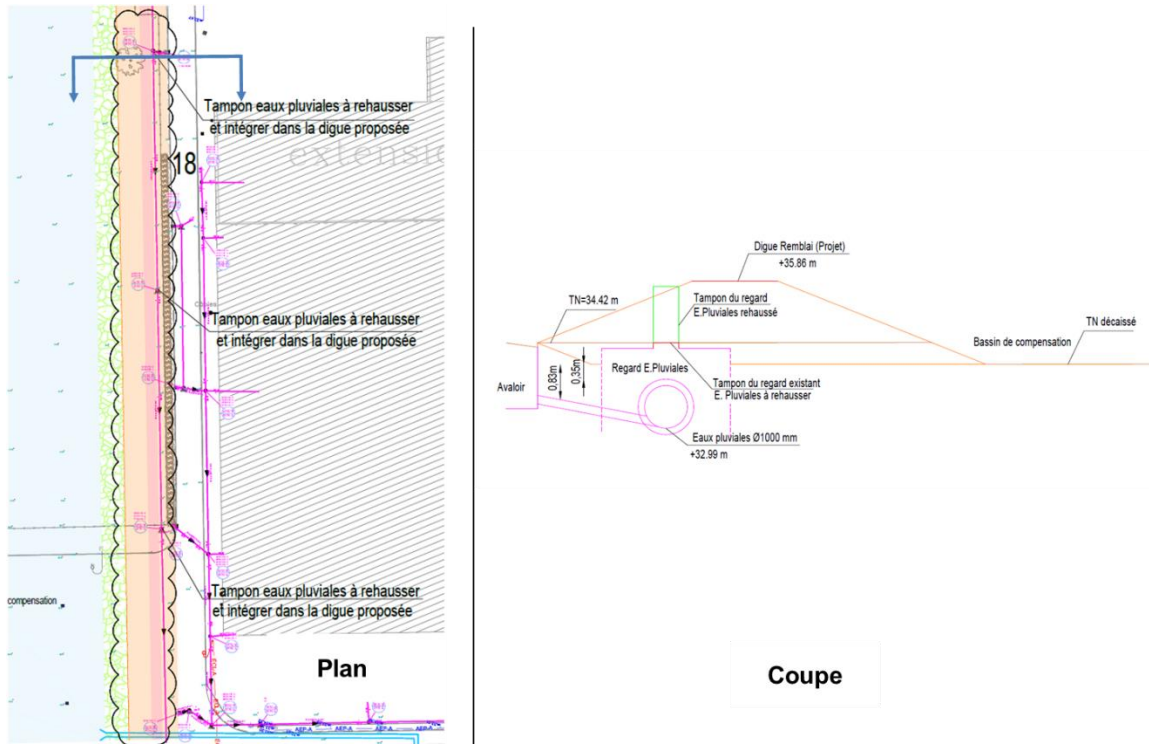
Remblai en chevauchement avec une conduite d'EP et traversant une conduite d'avaloir
